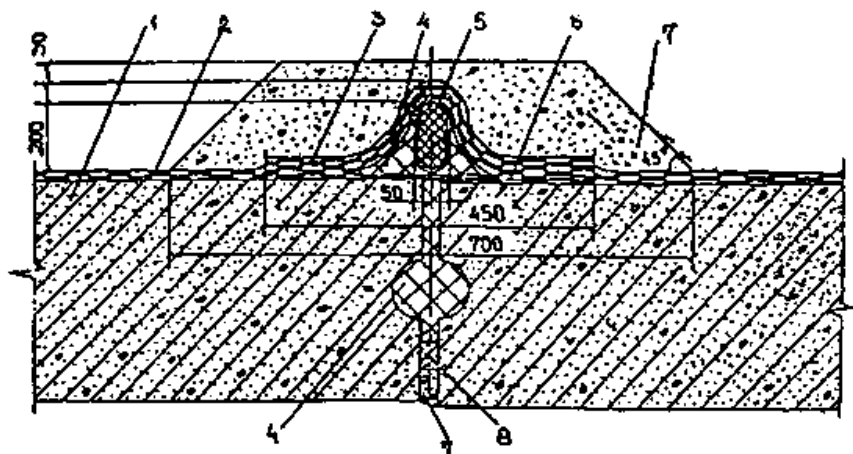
Конструкция гидроизоляции деформационного шва между стеновыми блоками:
